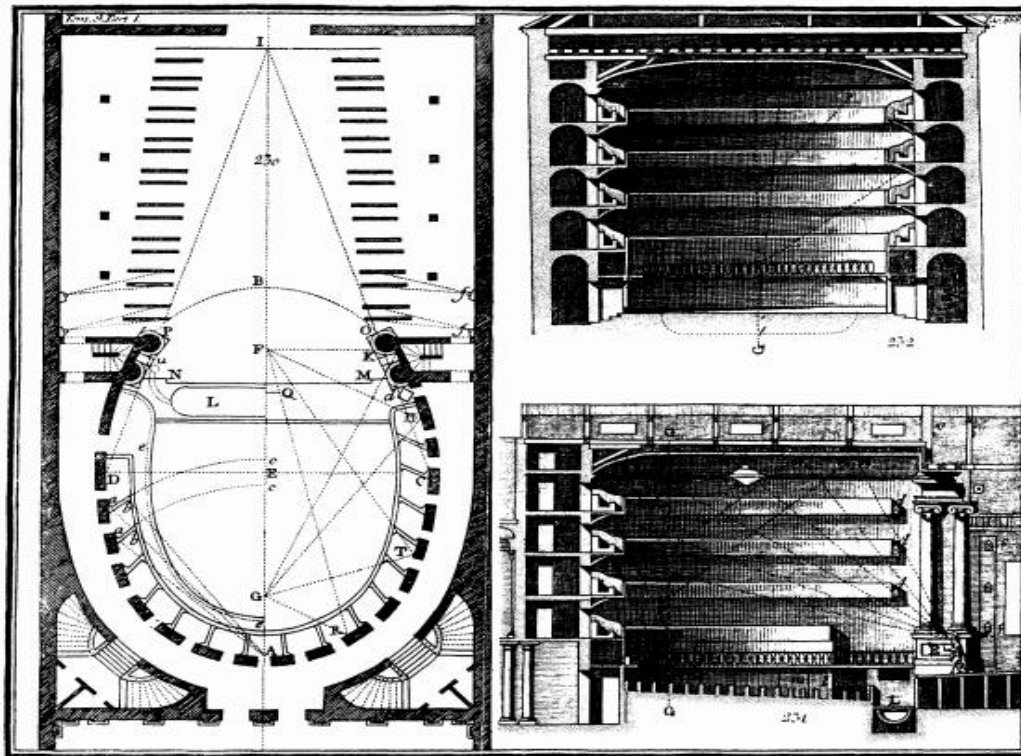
, planta y secciones de la tipología defendida por Patte y Bails
